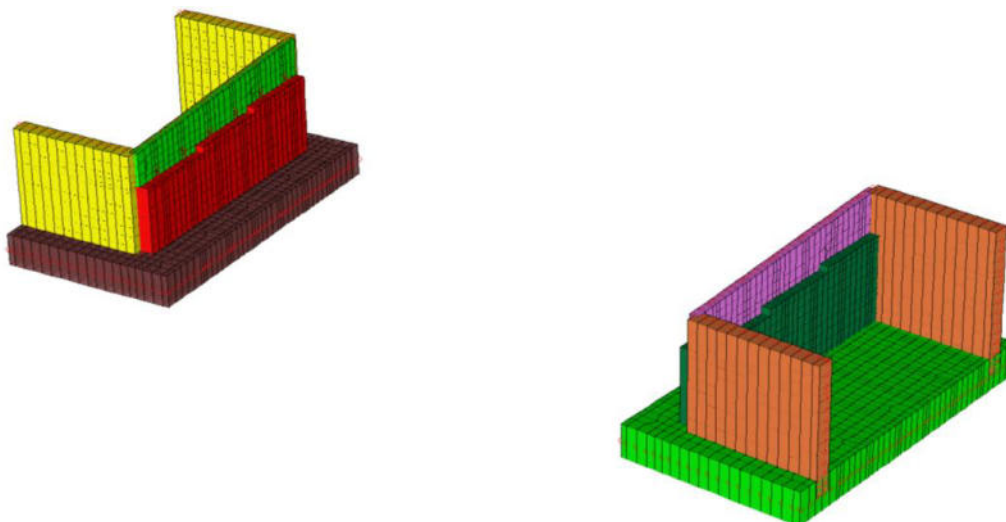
Modellazione ad elementi "shell" delle spalle
